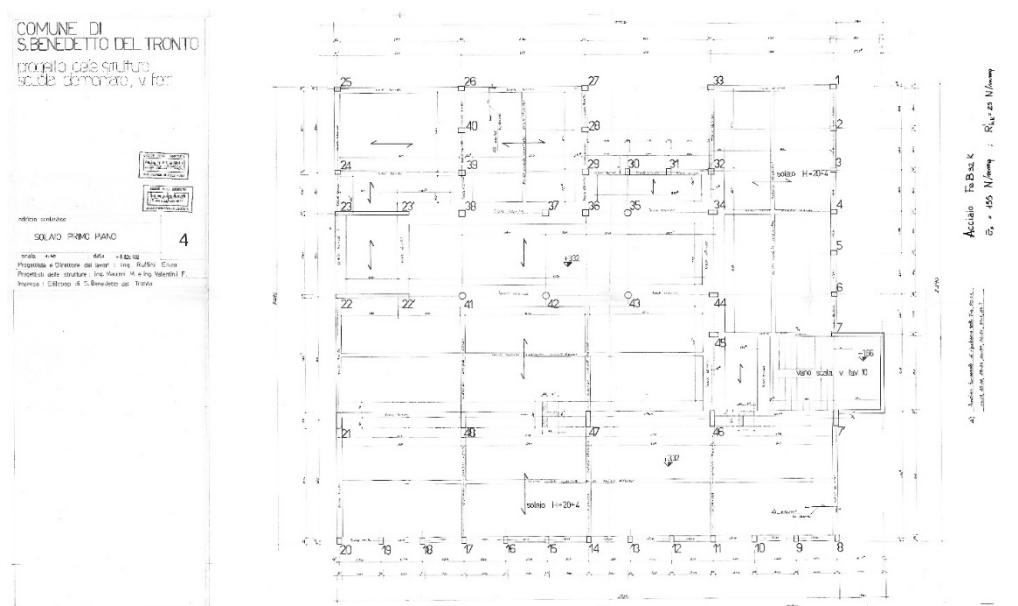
Tavola progetto originario- Carpenteria piano primo
